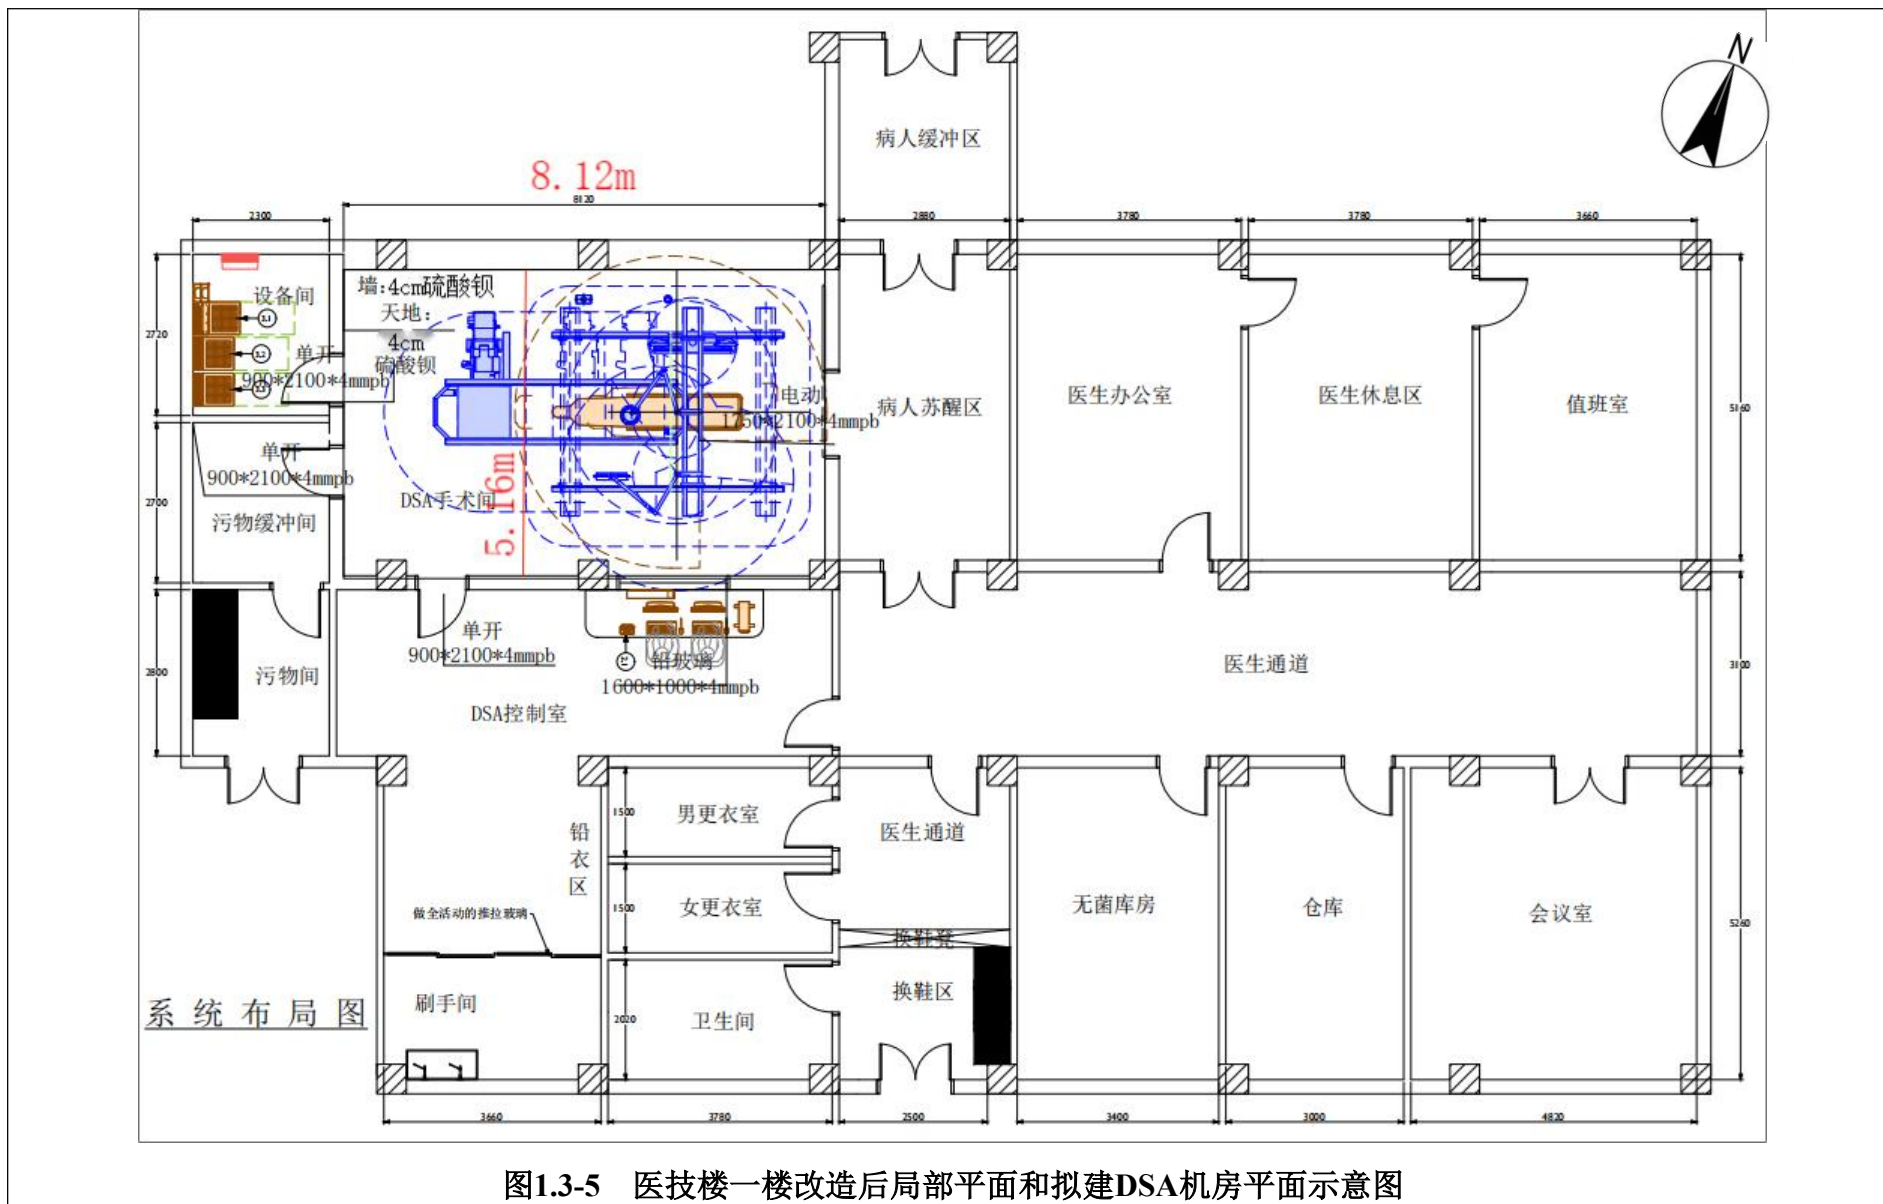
医技楼一楼改造后局部平面和拟建DSA机房平面示意图
